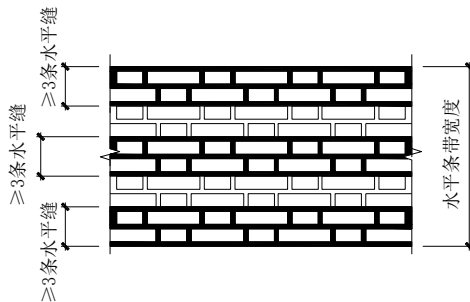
高延性混凝土水平条带嵌缝示意图
